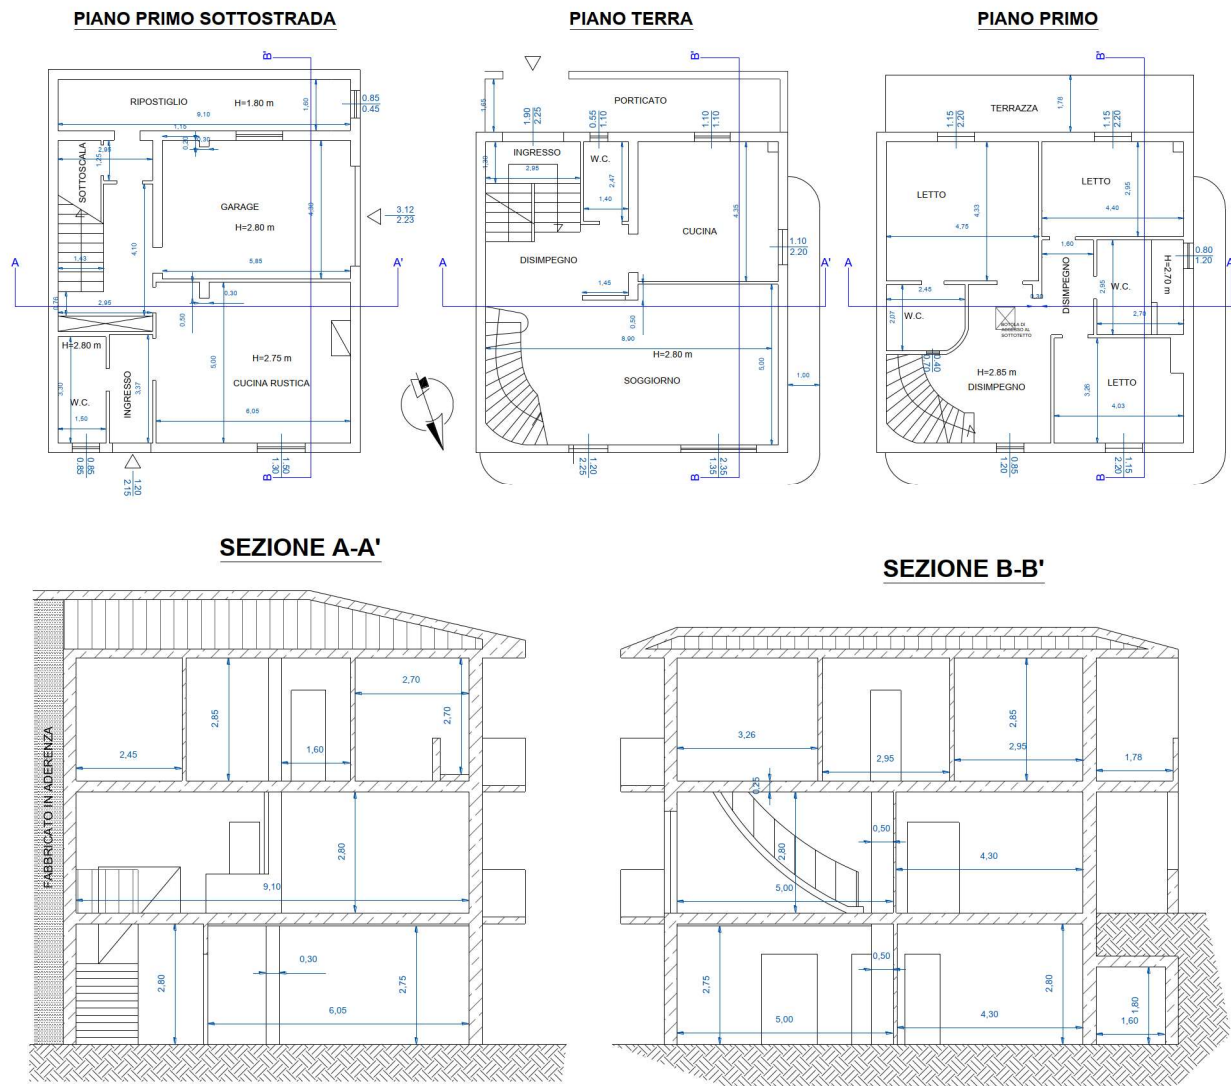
Rilievo subalterno 2 – Pianta e sezioni
